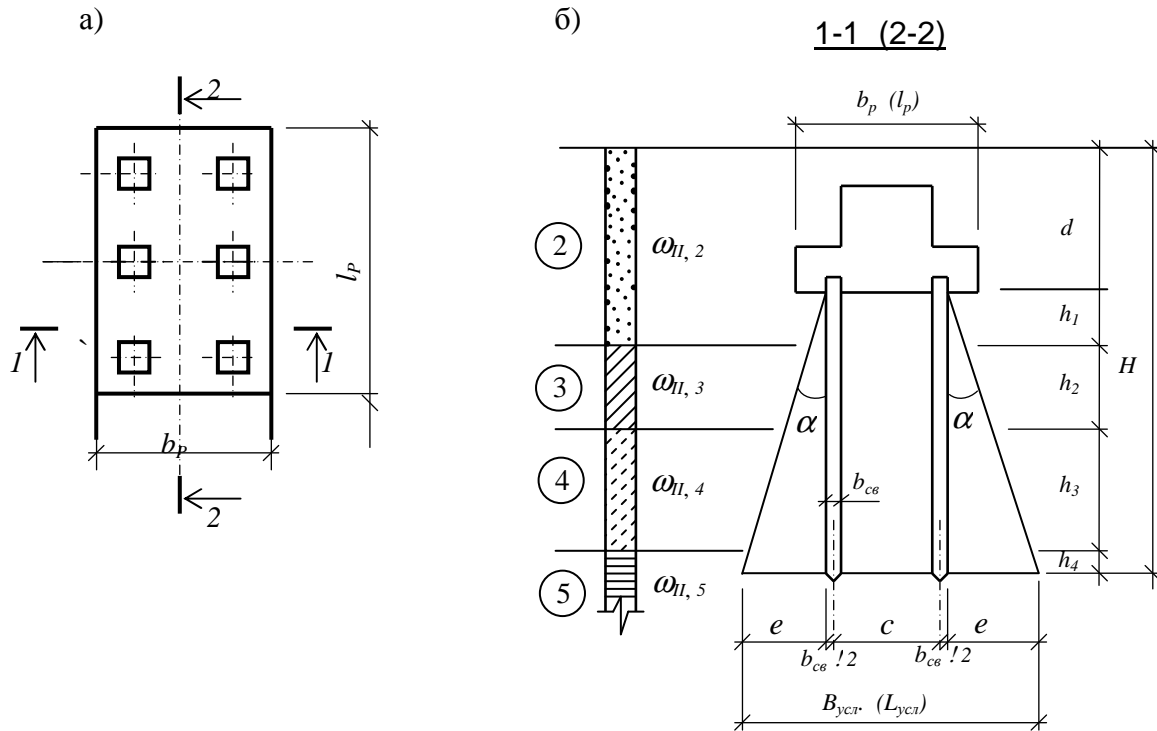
Схема к расчету условной ширины (длины) подошвы свайного фундамента
